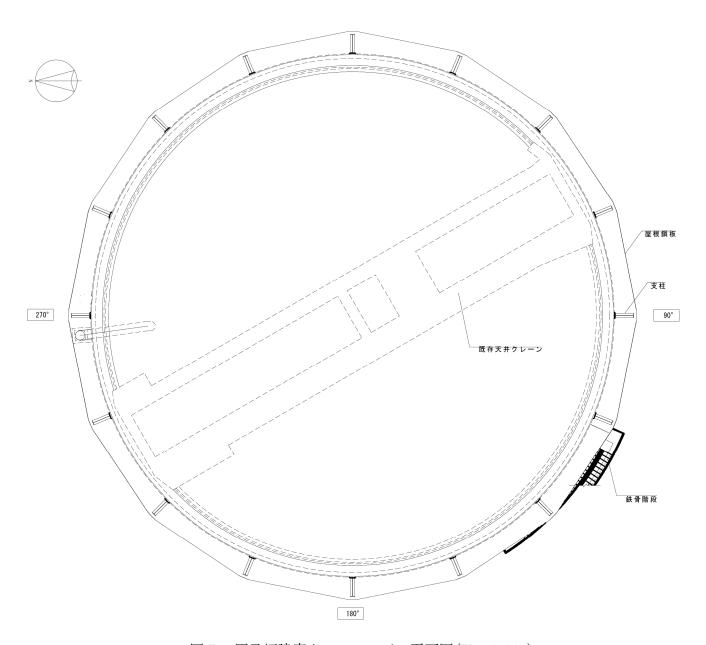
原子炉建家クレーンレベル平面図(FL+19,000)
